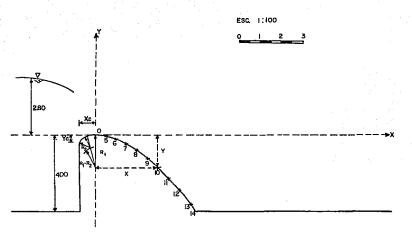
PERFIL DEL CIMACIO TIPO CREAGER.
